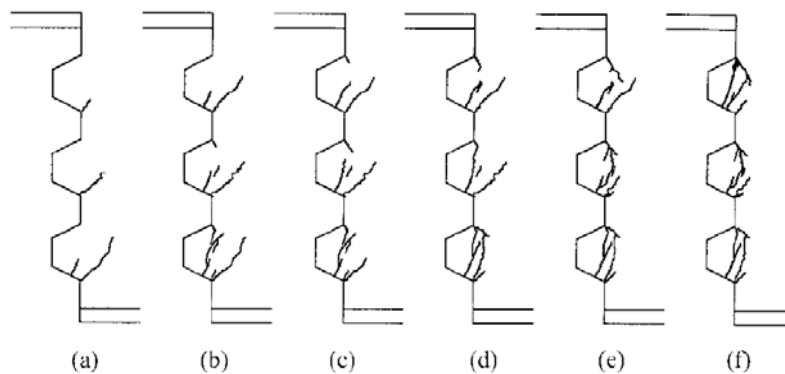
Evolución de las grietas para junta seca con tres llaves [20]
